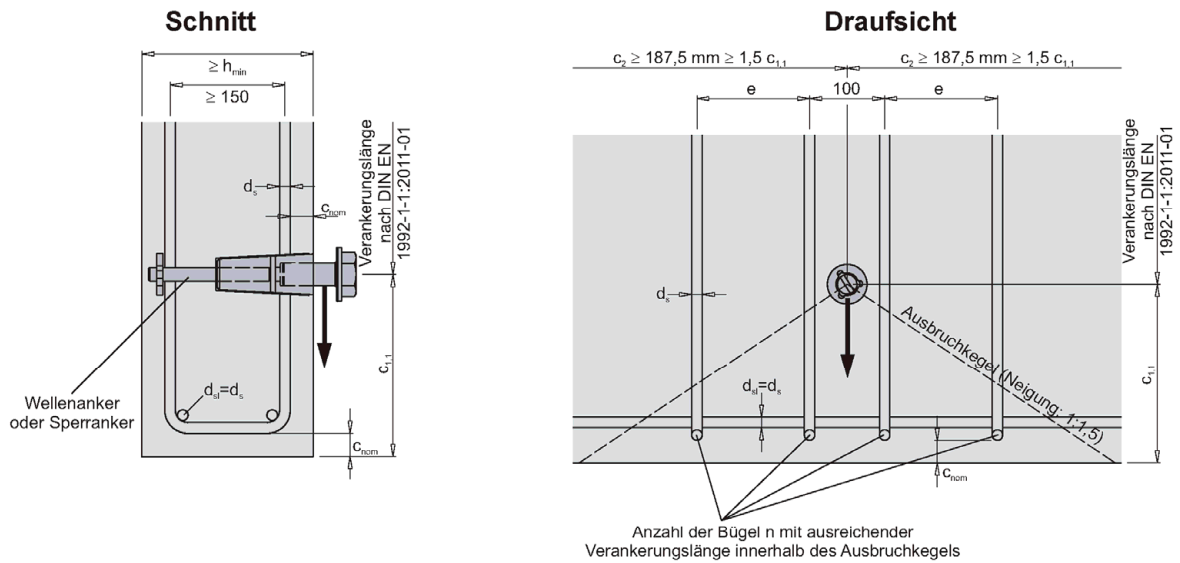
Einbausituation in Wänden - Querbeanspruchung mit Rückhängebewehrung - Bewehrungslage
